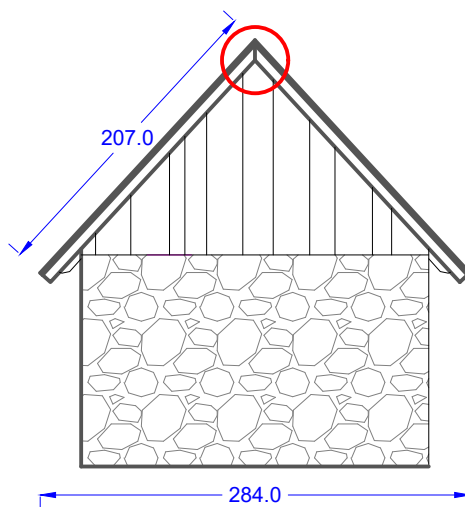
Piec chlebowy, elewacja północna (fot. K. Oziębłowska, lipiec 2023 r.).
